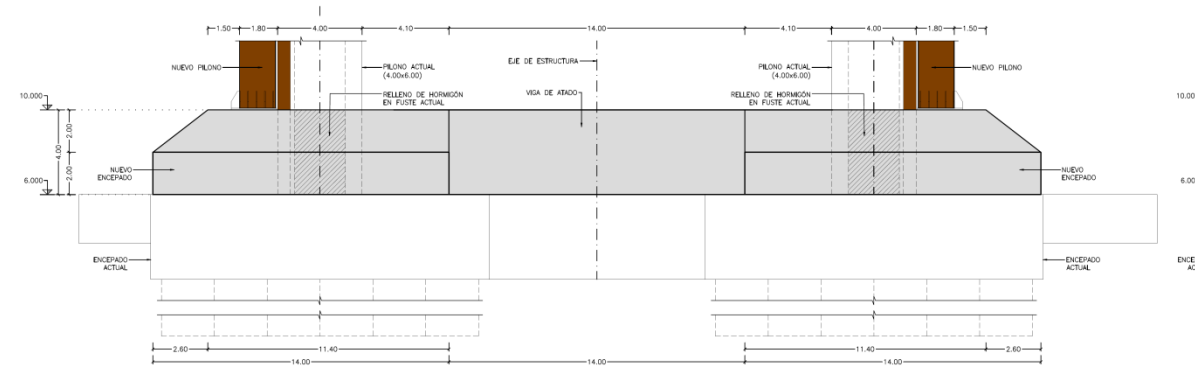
Vista en alzado de la nueva zapata sobre el encepado actual.
